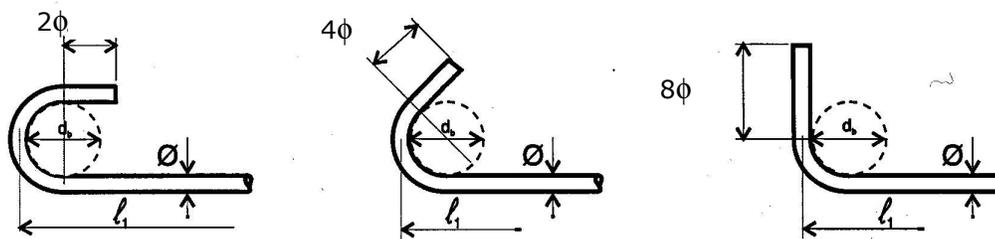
Ganchos das barras da armadura longitudinal de tração.
